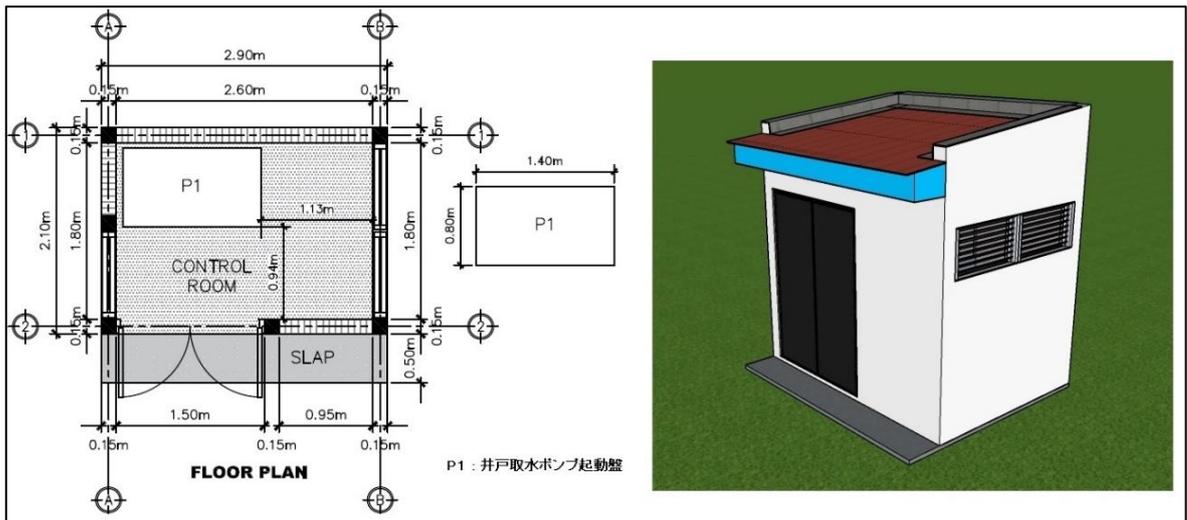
Vista en Planta y Exterior de la Sala de Operación
